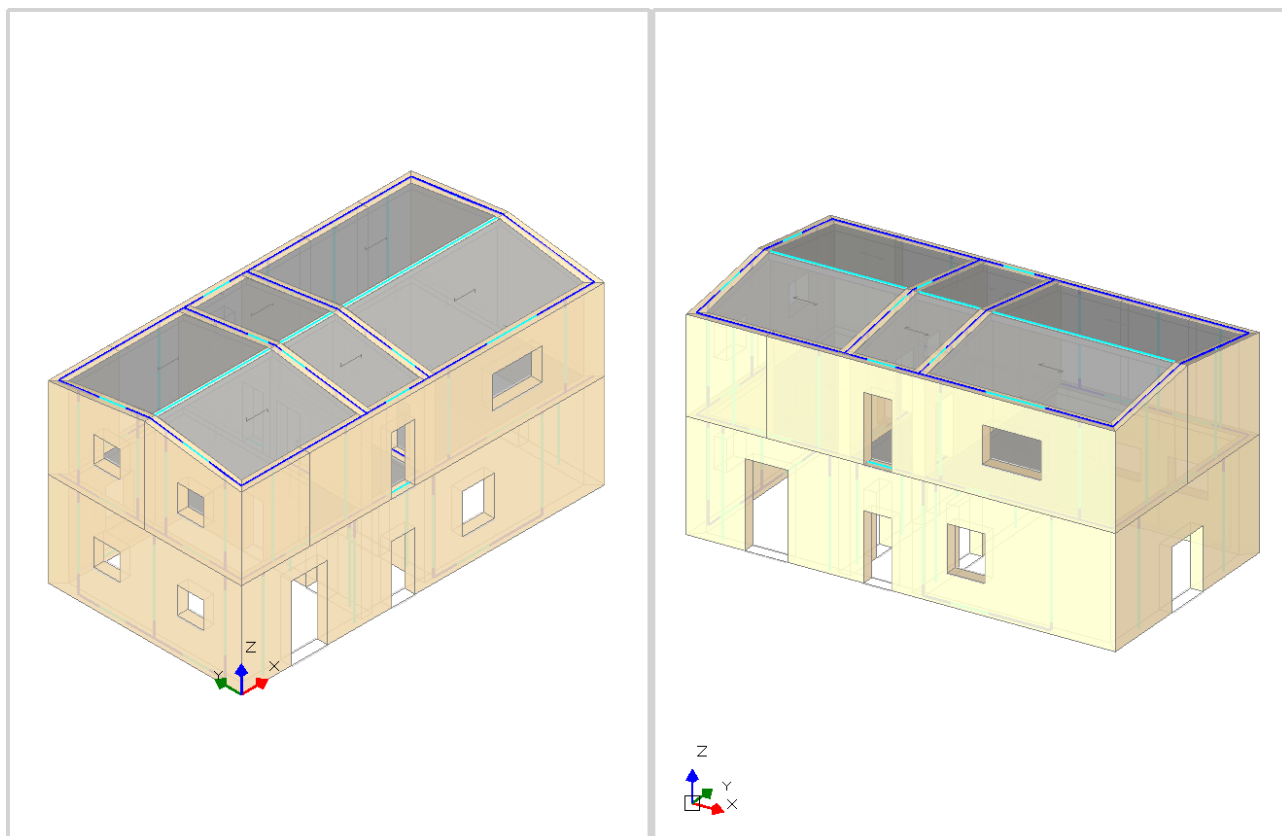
Viste assometriche da Sud-Ovest e da Nord-Est
